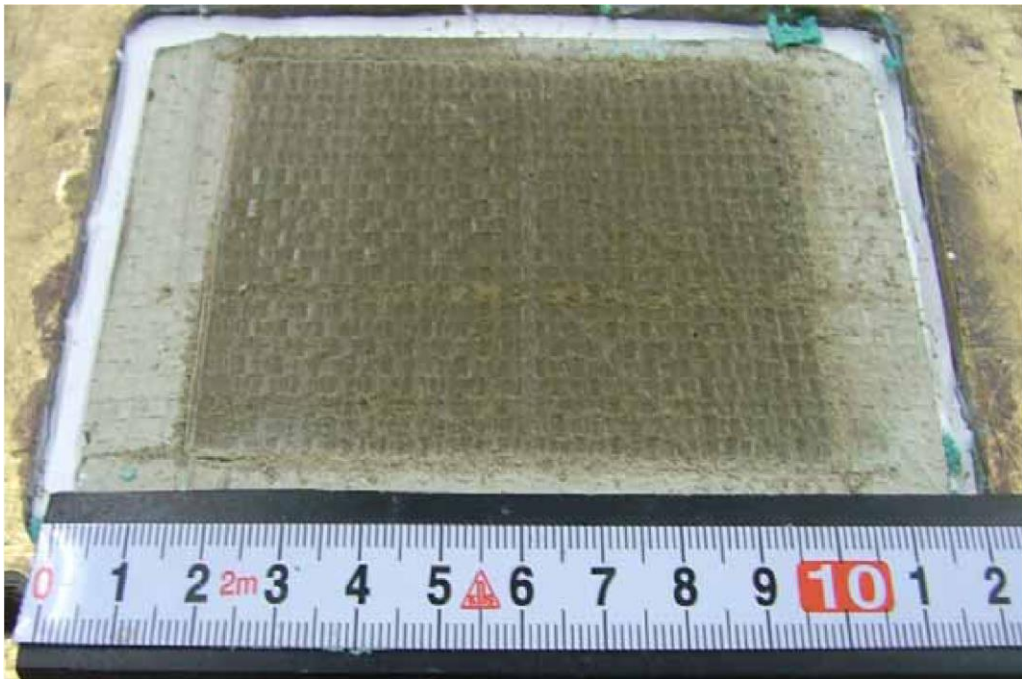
一方向載荷試験 一方向載荷試験後の供試体状況
